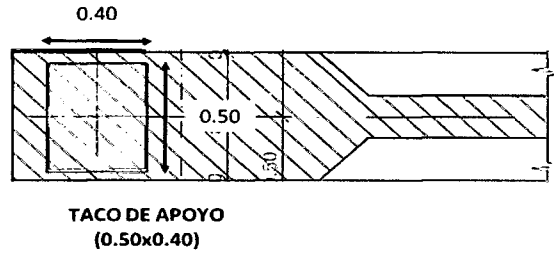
Detalle en planta de apoyo de madera o similar.
